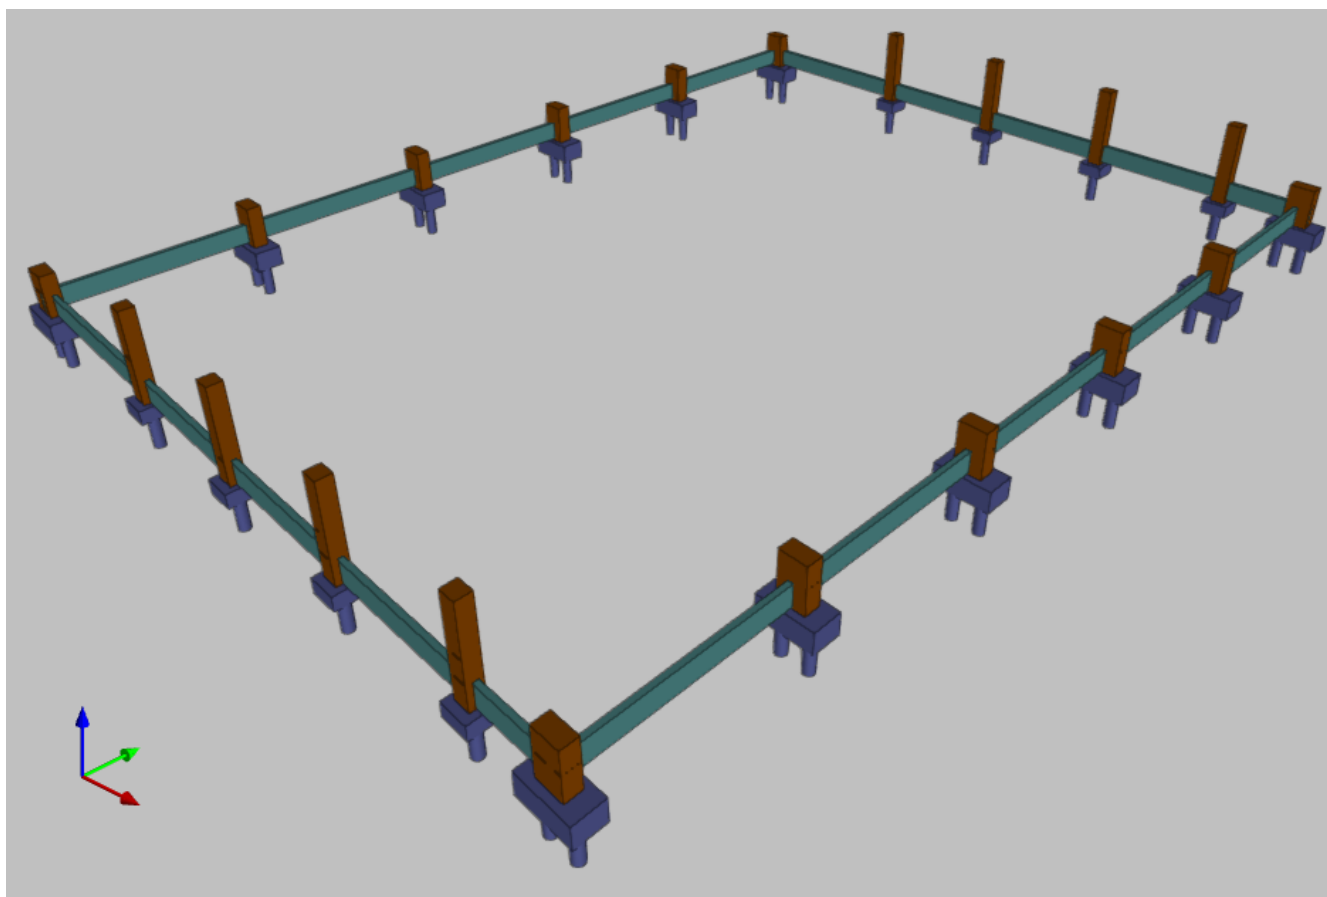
Quadra – Modelo estrutural 3D vista 1
